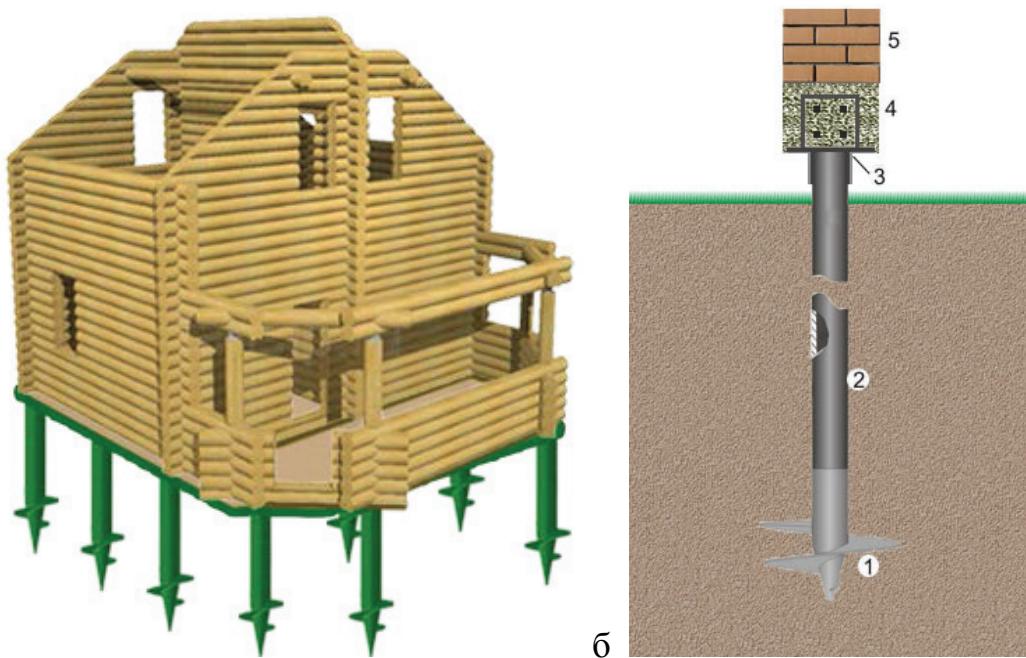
Общий вид фундамента из винтовых свай: а – для деревянного строения; б – для кирпичного здания; 1 – винтовая лопасть; 2 – стальной столб; 3 – оголовок; 4 – железобетонный пояс; 5 – стенка цоколя из кирпича
